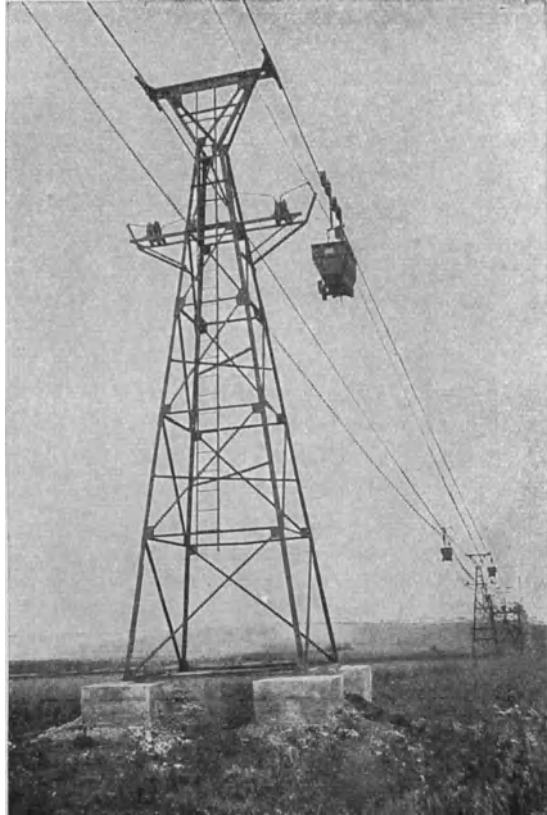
Eiserne Bockstütze leichter Ausführung (Kaiser & Co.).
